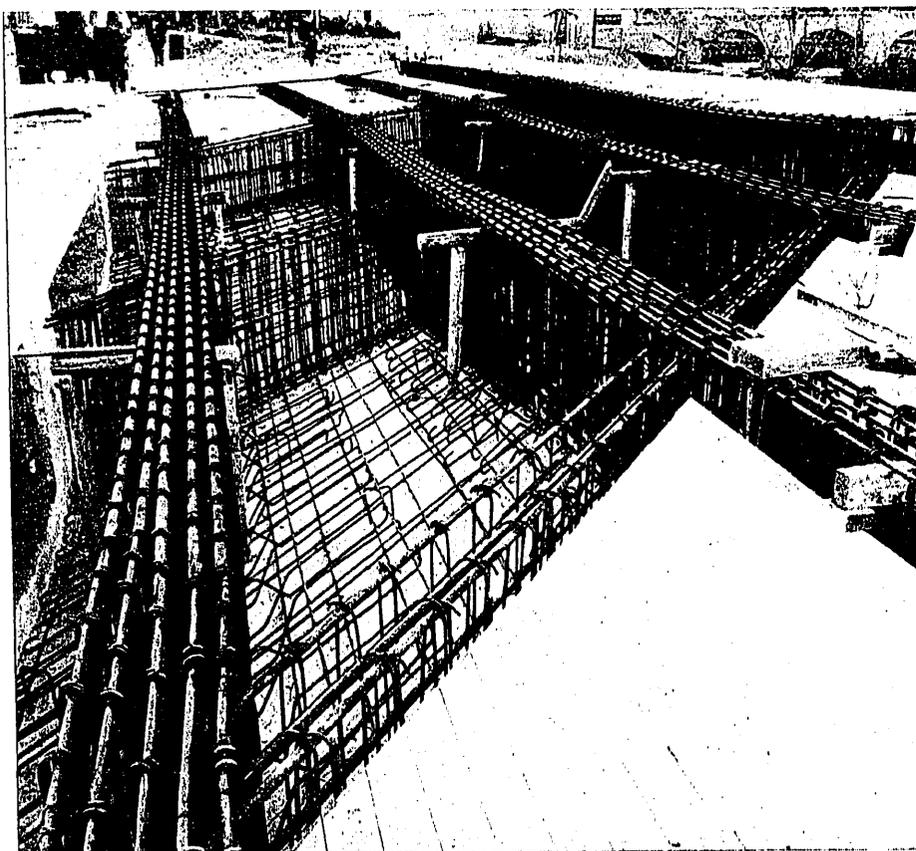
Vista del armado de las vigas principales, transversales y forjado inferior
